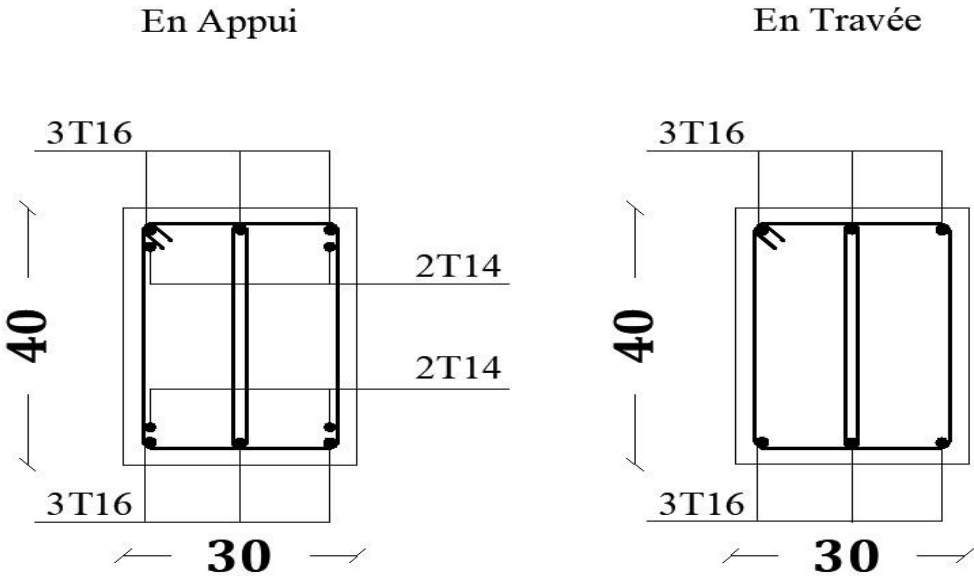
Schéma de ferrailage de la poutre principale 30x40
